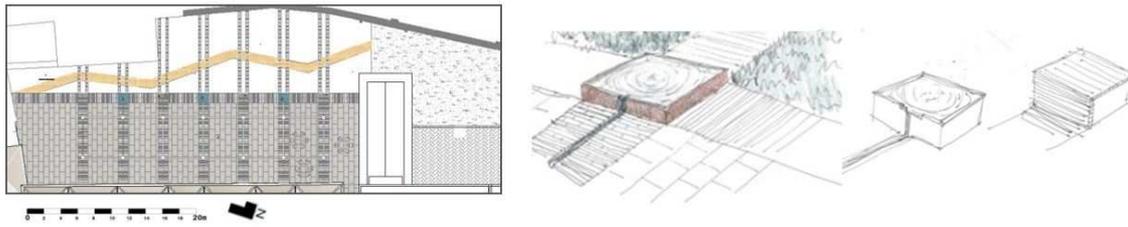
Imagem da Planta com estereotomia do pavimento e estrutura da água-aspecto da ligação entre caldeiras de pavimento e caldeiras de árvores; à direita, esquiços das “caixas-de-água” e “caixas-de-sentar” que alternam.
